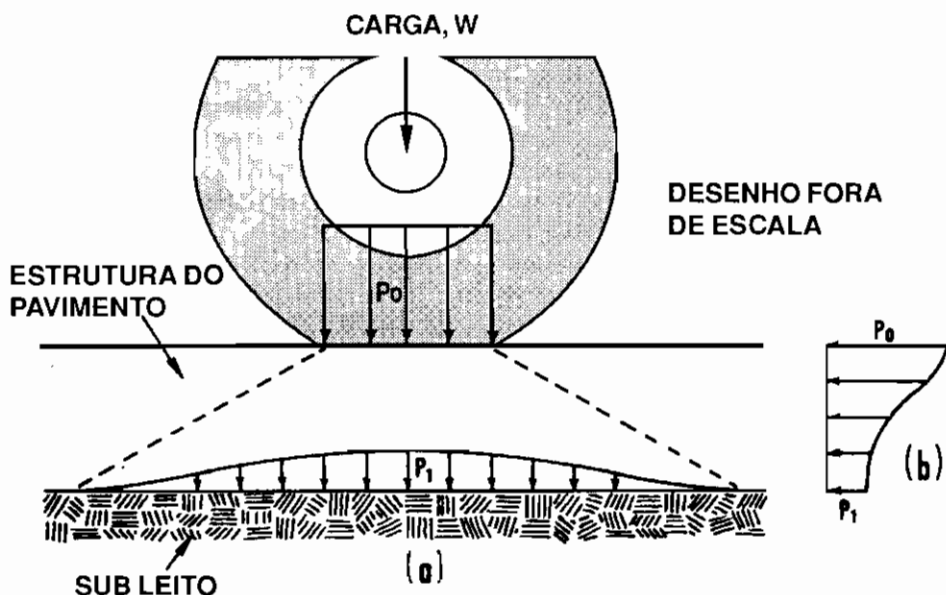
Espalhamento de Carga de Roda Através da Estrutura do Pavimento
